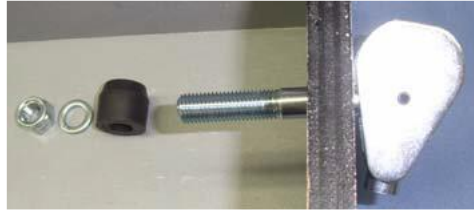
Fijador del conector al molde y accesorios. (Ref. 10)
